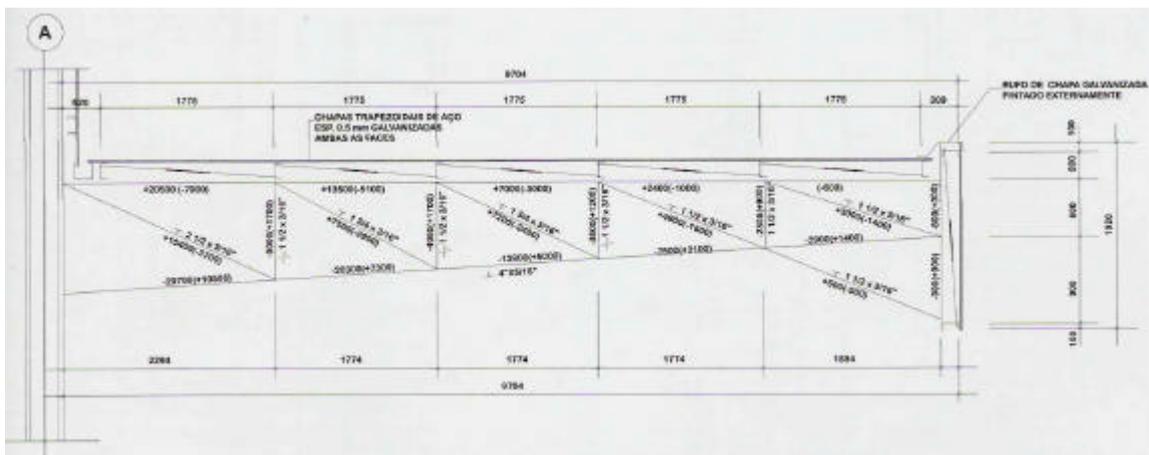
Elevação marquise metálica: projeto de engenharia
